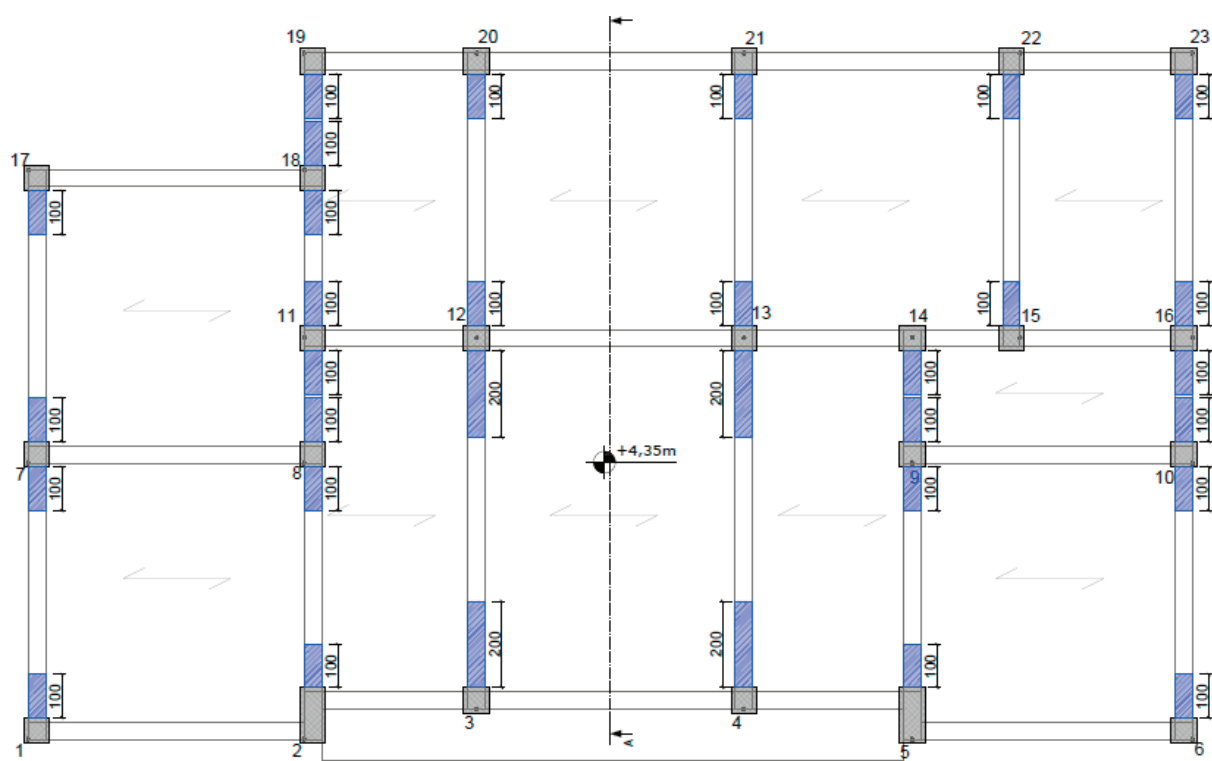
Ringrosso travi – Estratto pianta e particolare
